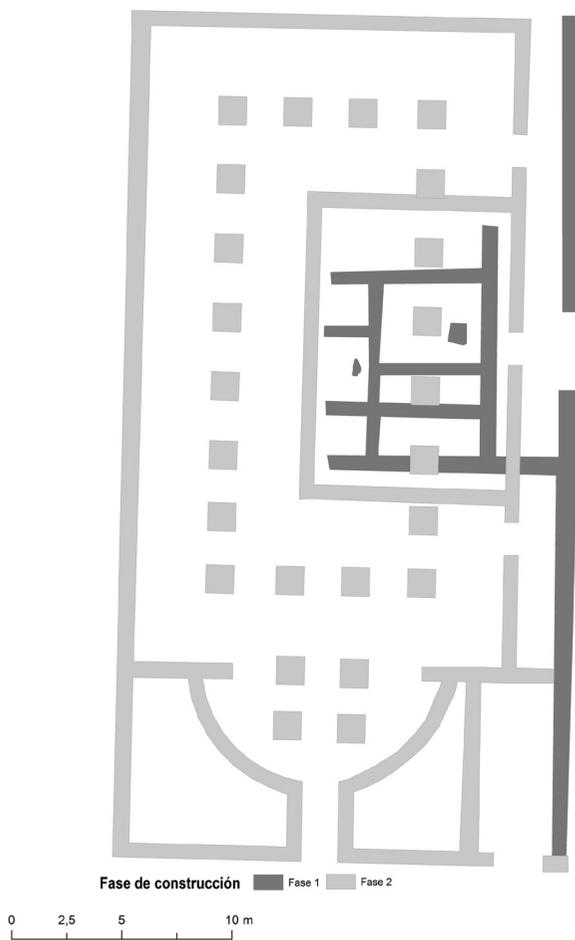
Reconstrucción de la planta del lado o del foro; en negro estructuras pertenecientes a la primera fase.
